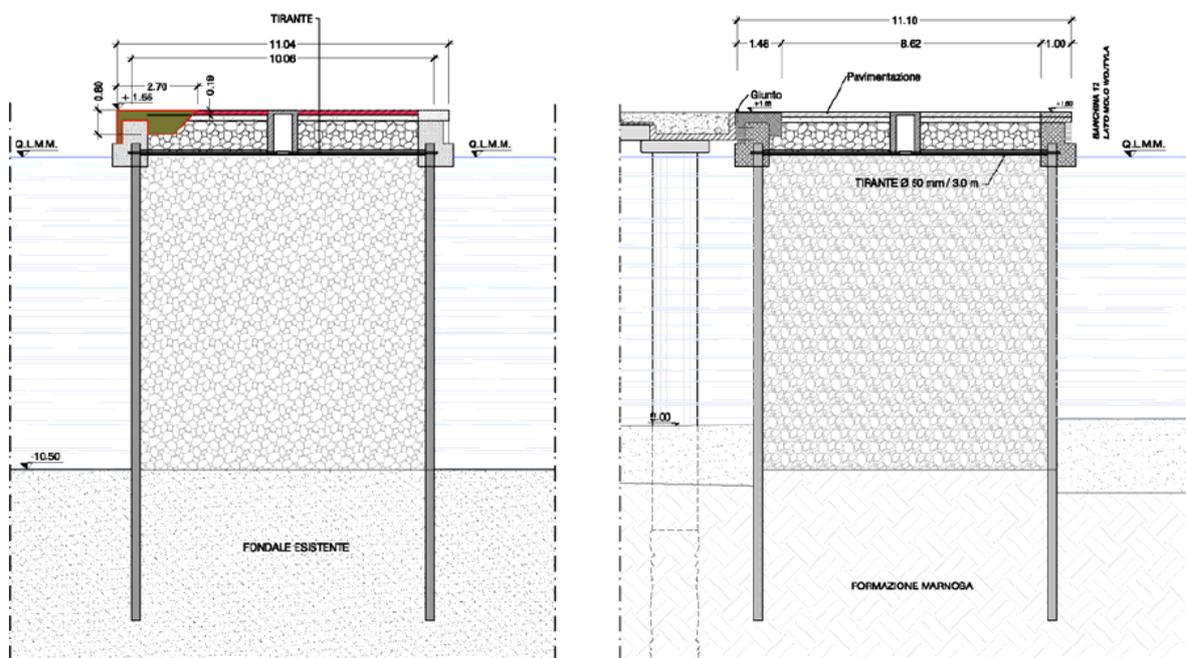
Demolizione e ricostruzione tratto di banchina esistente in palancole metalliche
